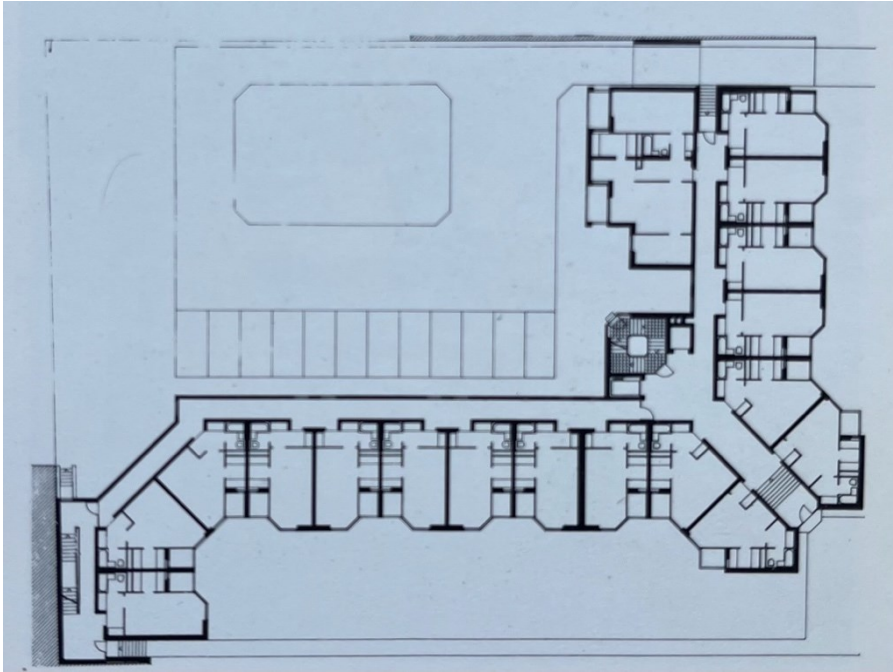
Hans-Heinrich Moldenshardt Altenwohnheim Schlossstraße 2, Grundriss, Gebäudeecke als Eingang, 1969, Berlin.
